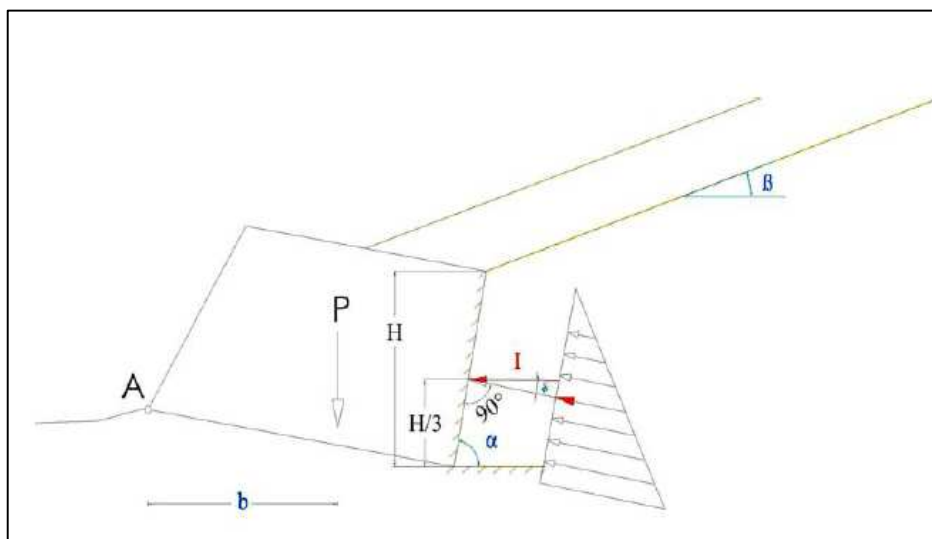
Esquema de forças sobre o muro de suporte vivo com rotação da estrutura sobre o ponto A, (adaptado de Ribeiro, 2005).
